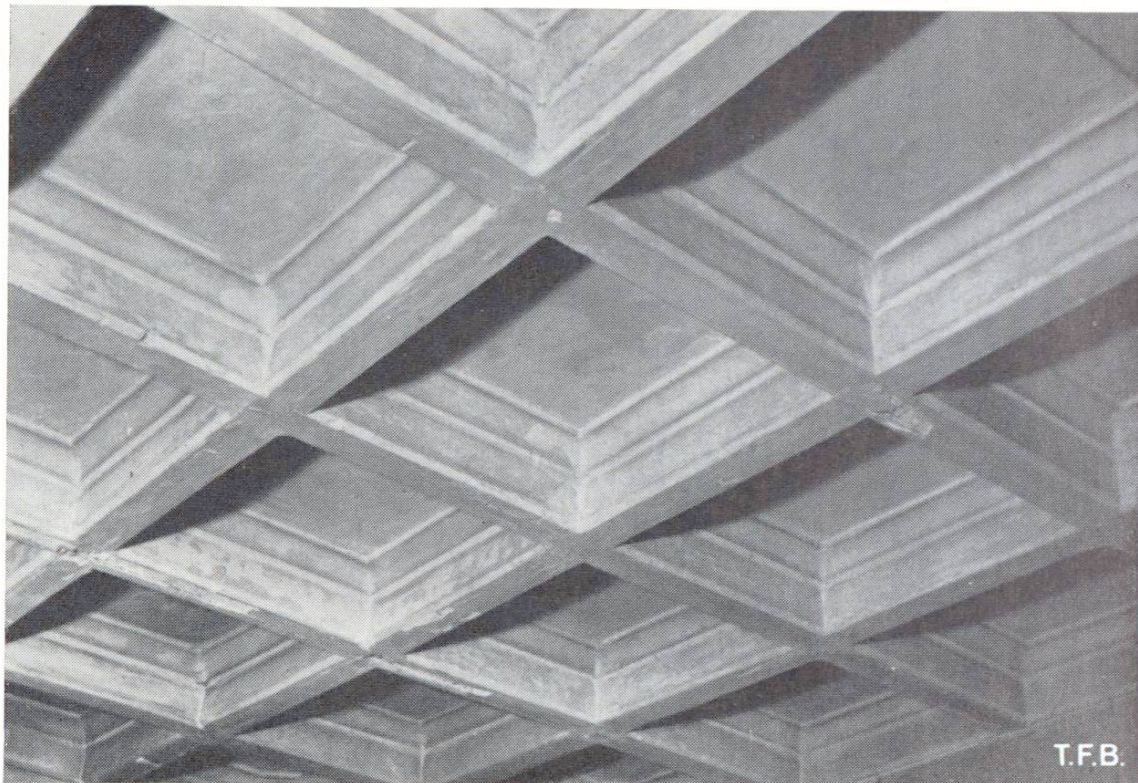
Plafond du rez-de-chaussée constitué par des caissons en plâtre séparés par un intervalle qui est bétonné, de même que la dalle qui les recouvre
